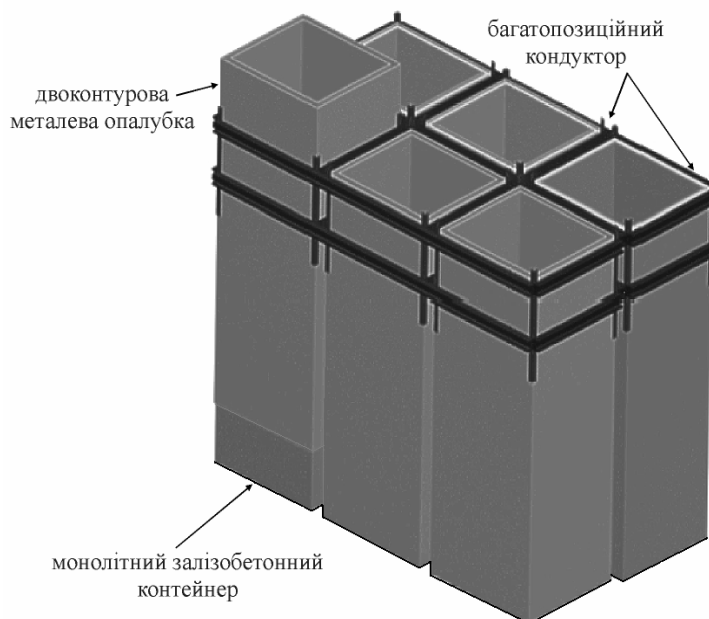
Зовнішній вигляд багатопозиційного кондуктора чарункового типу
